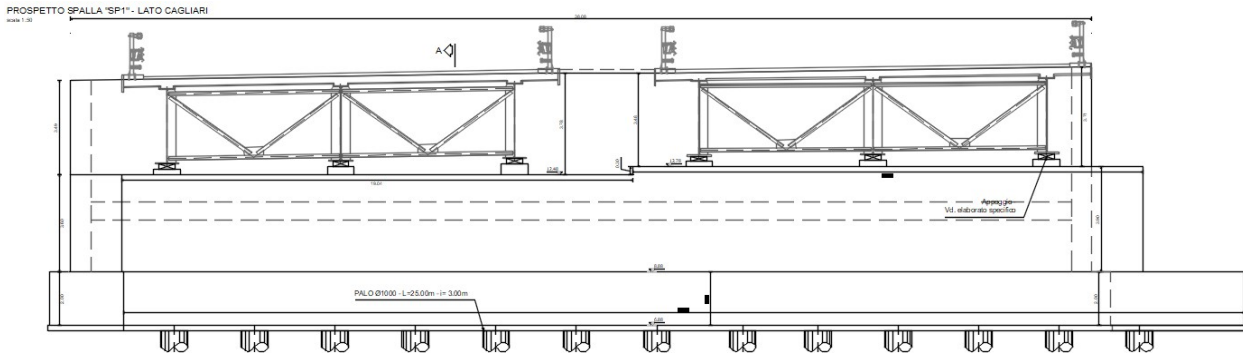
Prospetto spalla lato Cagliari
